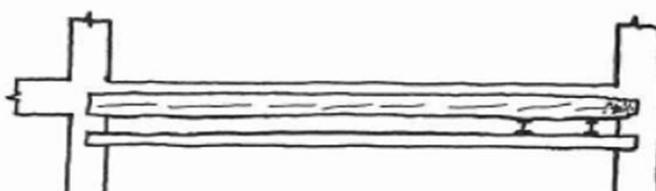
Reforço por colocação de perfis metálicos sob as vigas (Arriaga, 2002)
